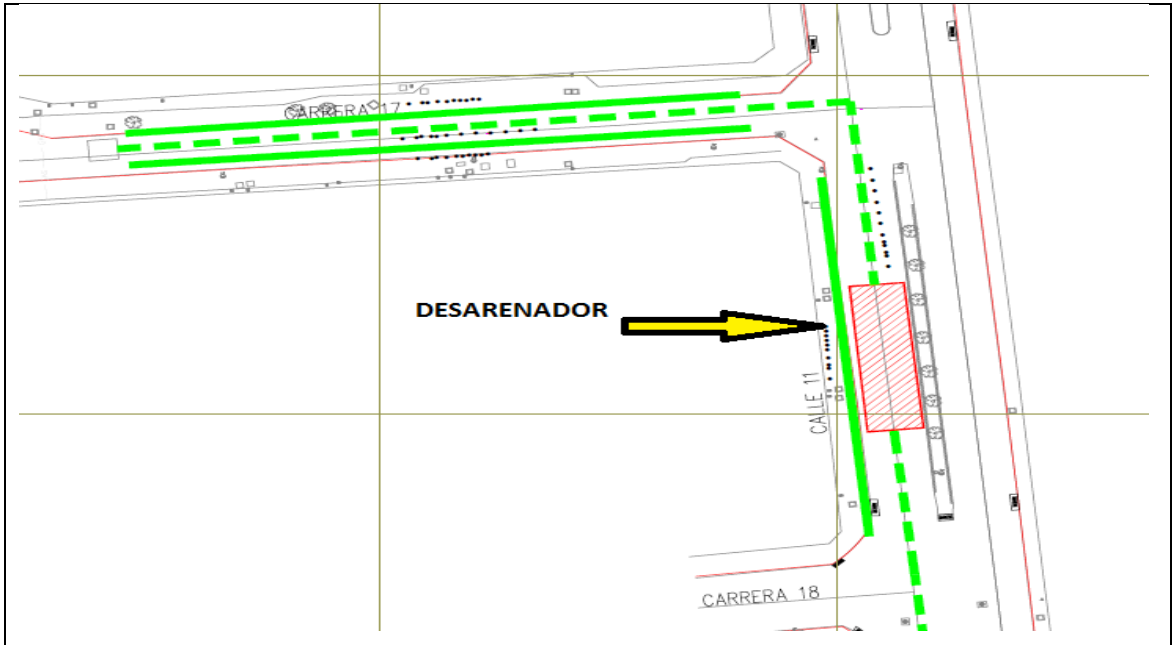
Desarenador a construir calle 11 entre carrera 18 y 17.
